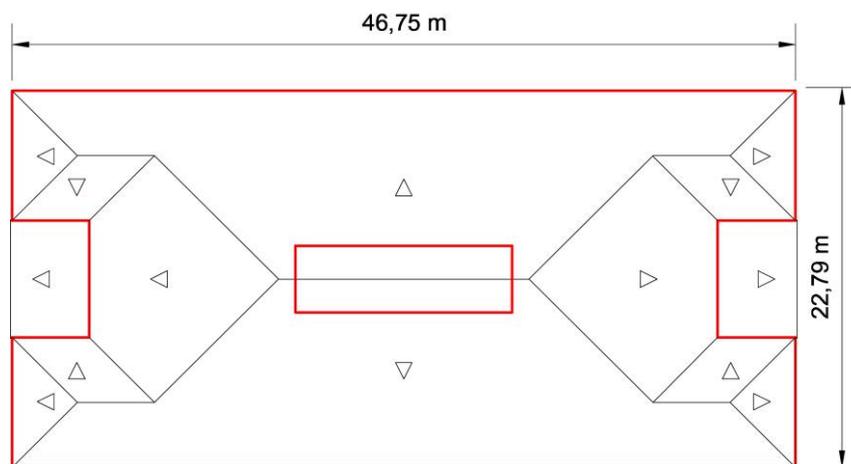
Ubicación de paramentos verticales de la cubierta.
